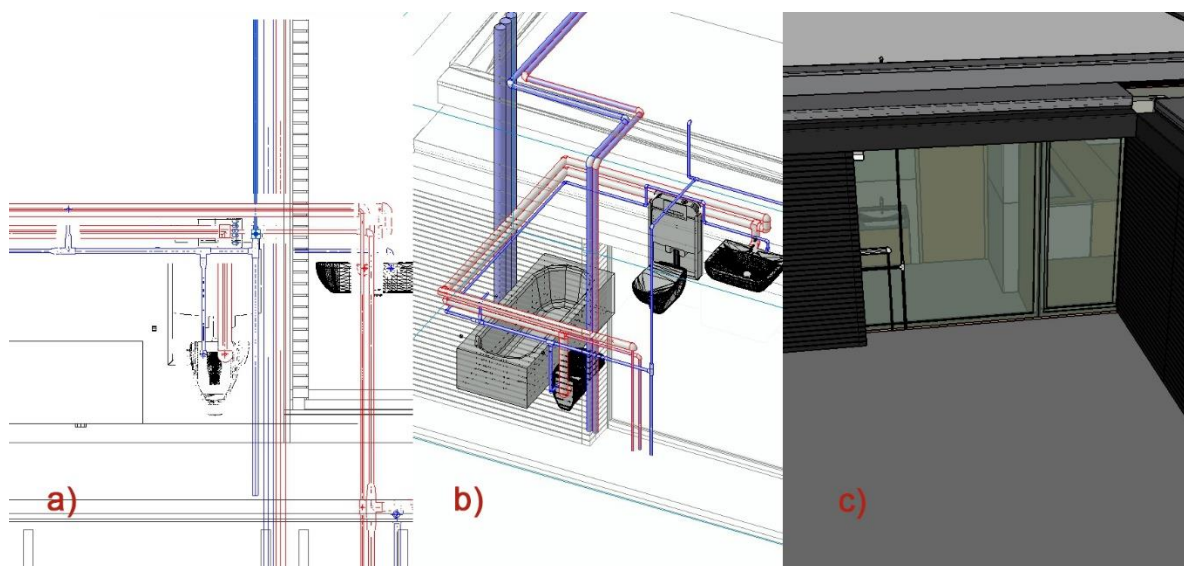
Representação de um erro ocorrido na modelação da rede de abastecimento; a) vista em corte b) vista 3D c) vista em sketchup.
